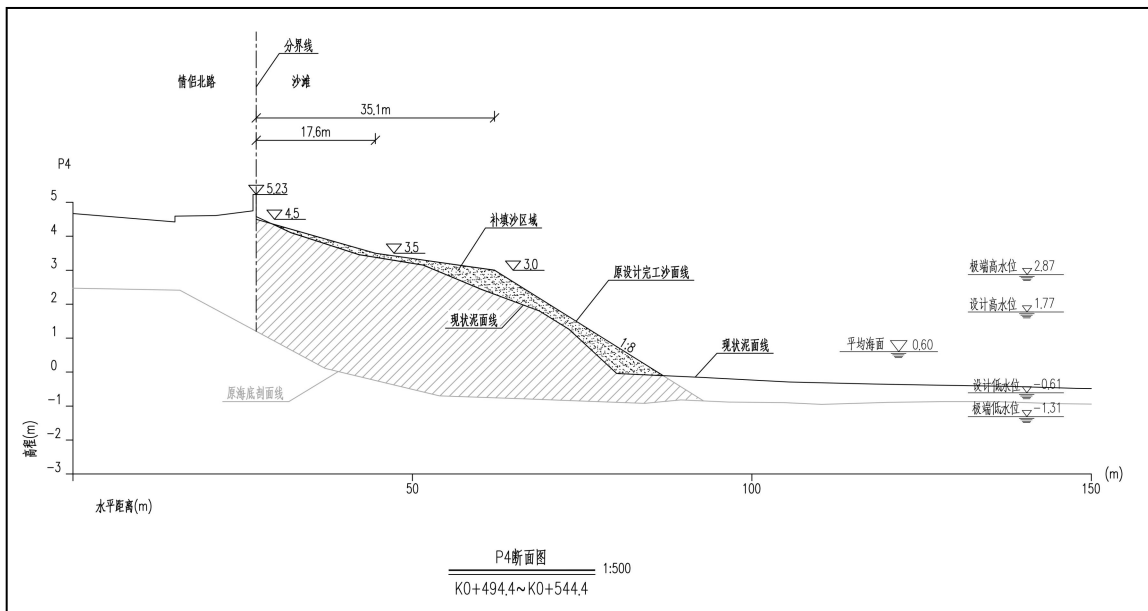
典型的补砂设计断面图 1 (P4 断面图)
